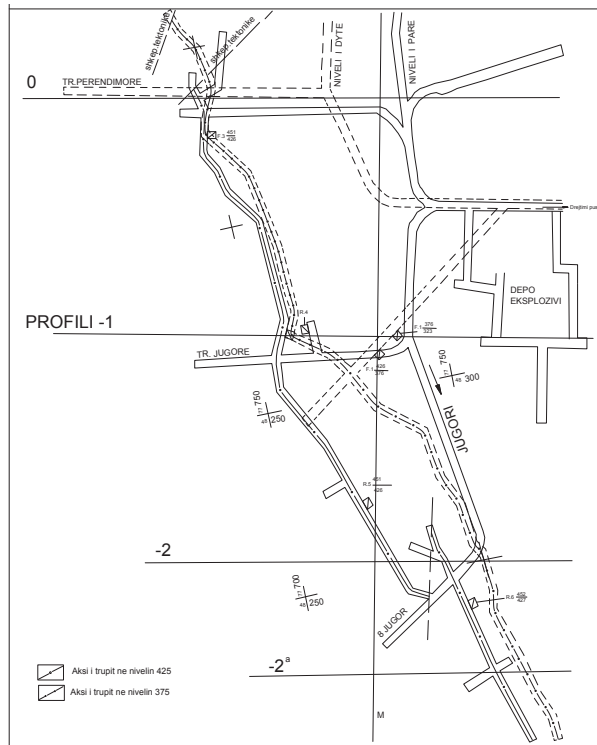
Planimetria e punimeve te minieres (pjesa veriore)
